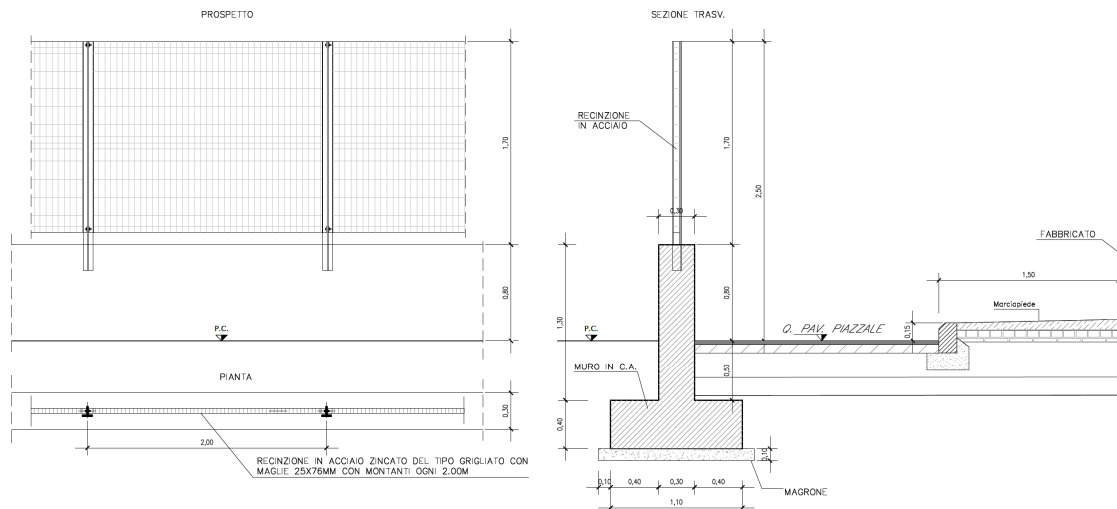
PT03 Particolare muro di recinzione, pavimentazione piazzale e marciapiede
